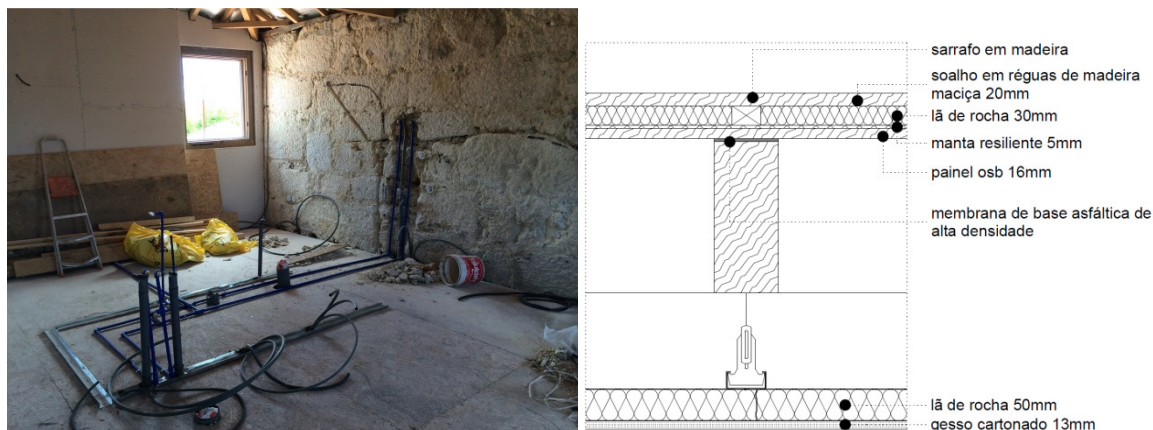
À esq. instalação de infraestruturas antes da aplicação do soalho (junho 2014), à dir. corte esquemático do pavimento entre fogos.
